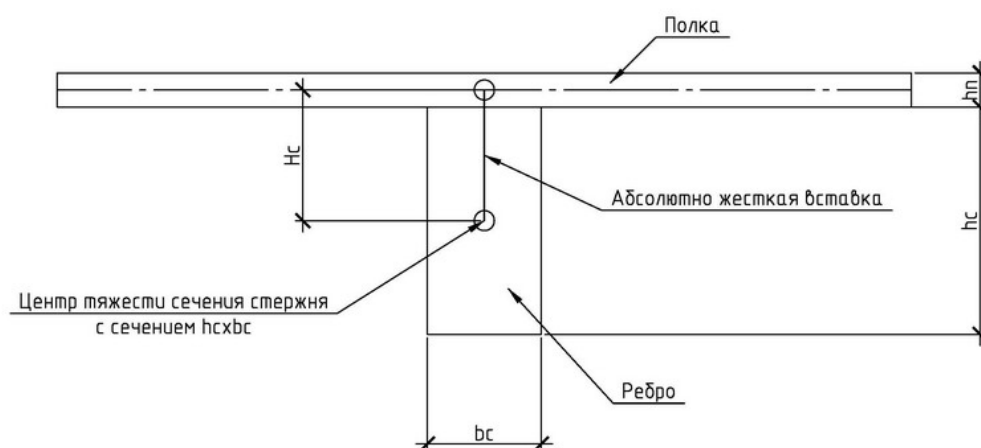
Моделирование перекрытия оболочечными элементами и стержнями с использованием абсолютно жестких вставок.
